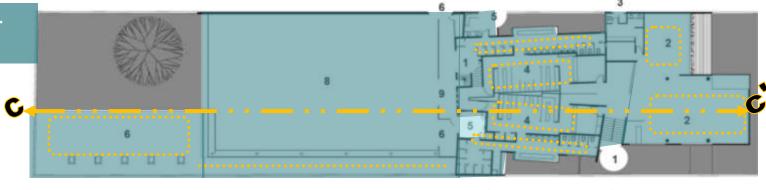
Planta segundo nivel. Fuente: Waterpoint.
